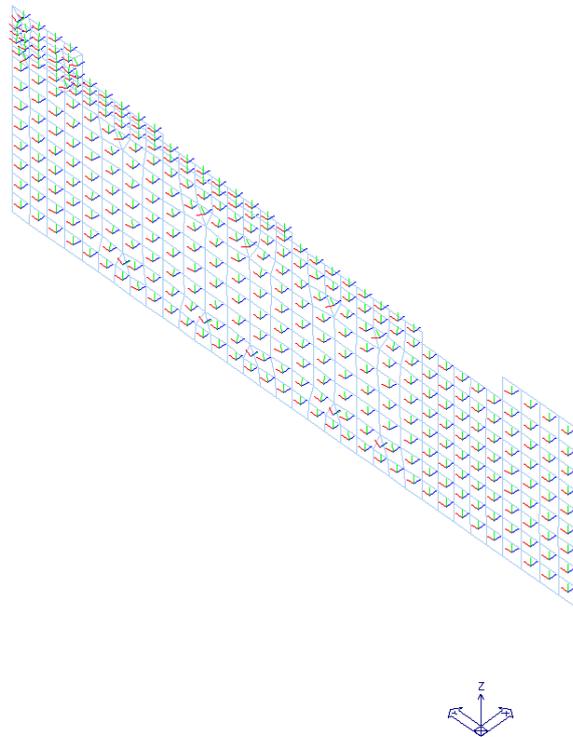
Muro frontale (sezione di verifica S1) – assi locali
